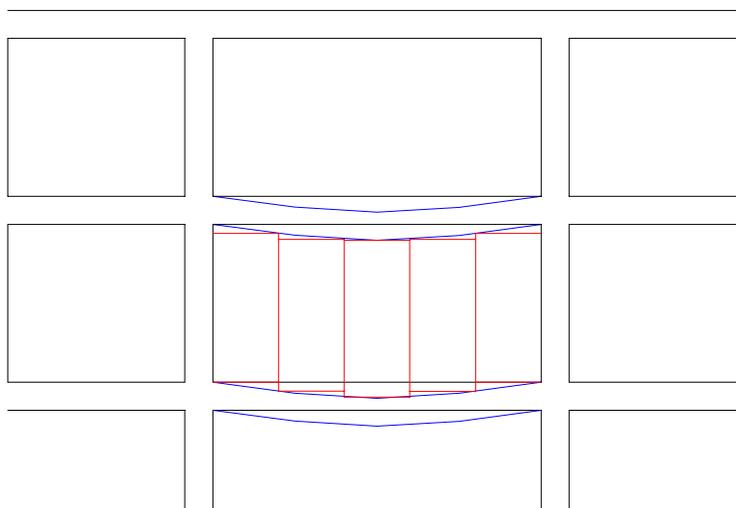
Fissuras em fechamentos pré-fabricados (painéis)
